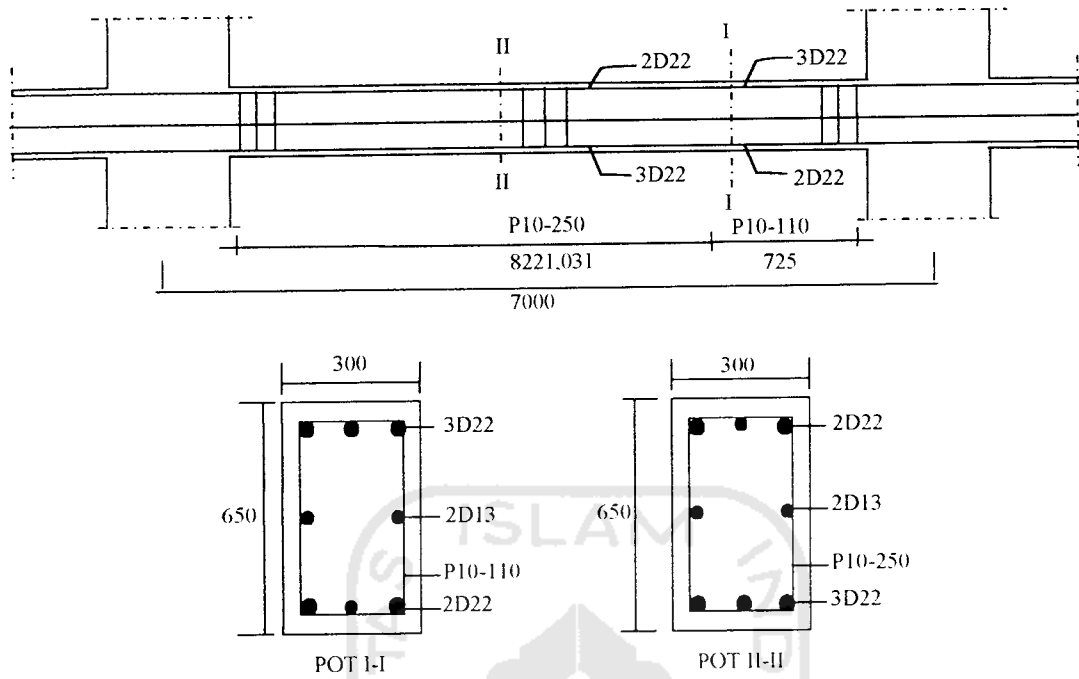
Balok Portal E Bentang 7m Lantai 10
